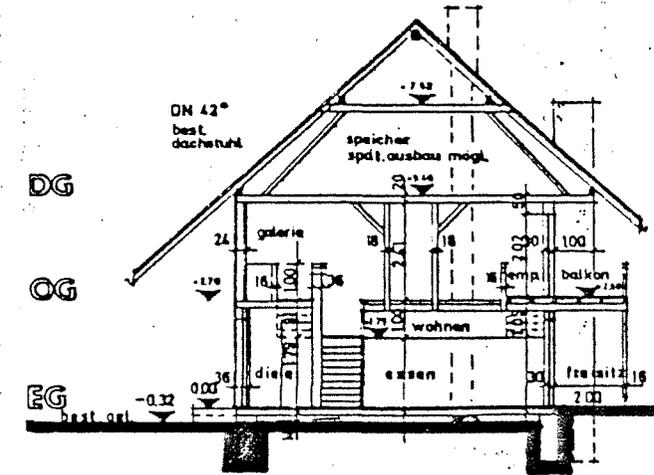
Gestaltungsvorschlag für den Einbau eines Treppenelementes in einen alten Ökonomieteil zur Erschließung des Dachgeschosses.
